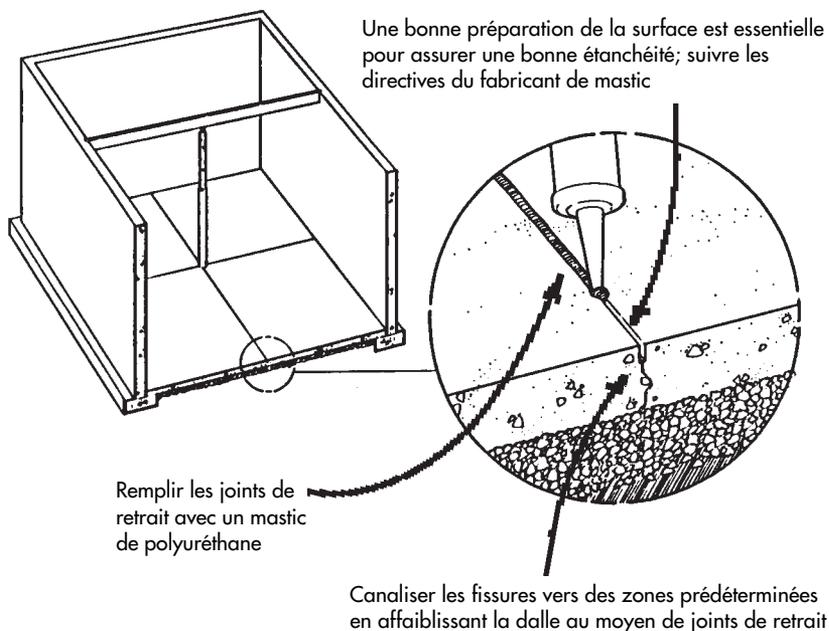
Joints de retrait pour les nouvelles dalles de plancher en béton
